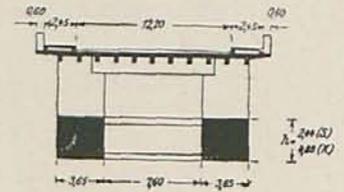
Puente sobre el Sena, en St. Pierre du Vauvray.
